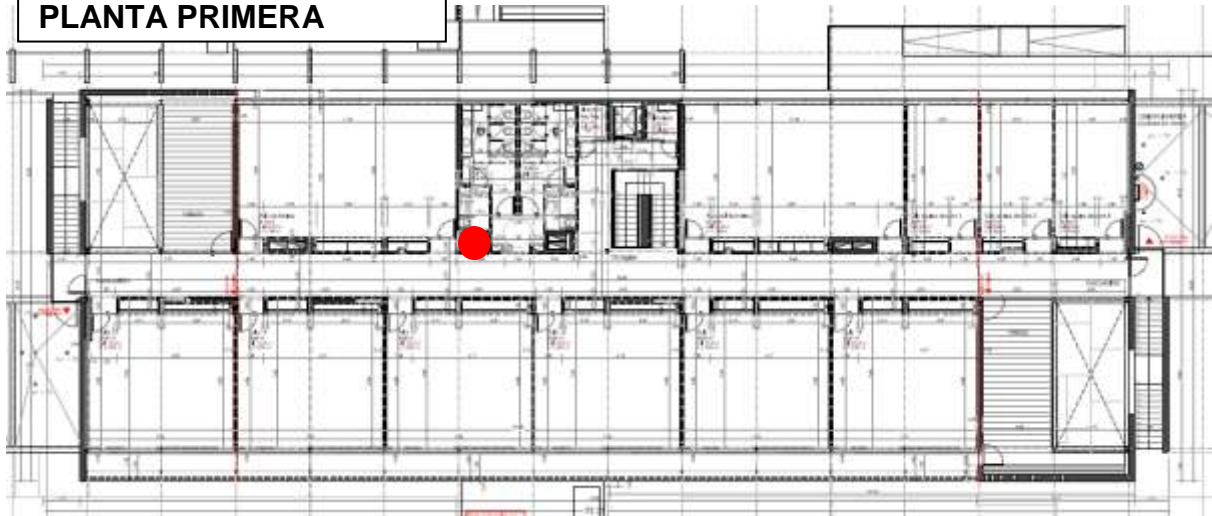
Plano Bloque 3, Planta Primera, localización de instalaciones
